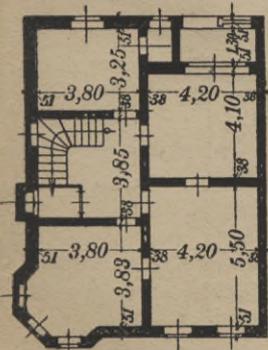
Erdgeschoß-Grundriß zu Abb. 222a.
